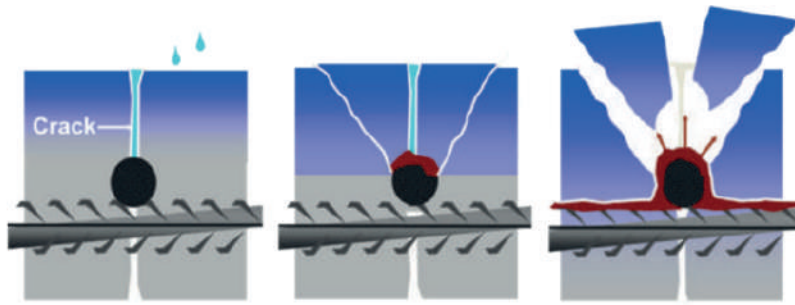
Deterioro del concreto reforzado por corrosión
